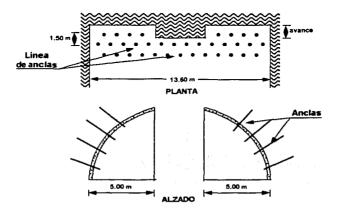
Anclaje de los laterales utilizando elementos de 4.2 o 6 m
